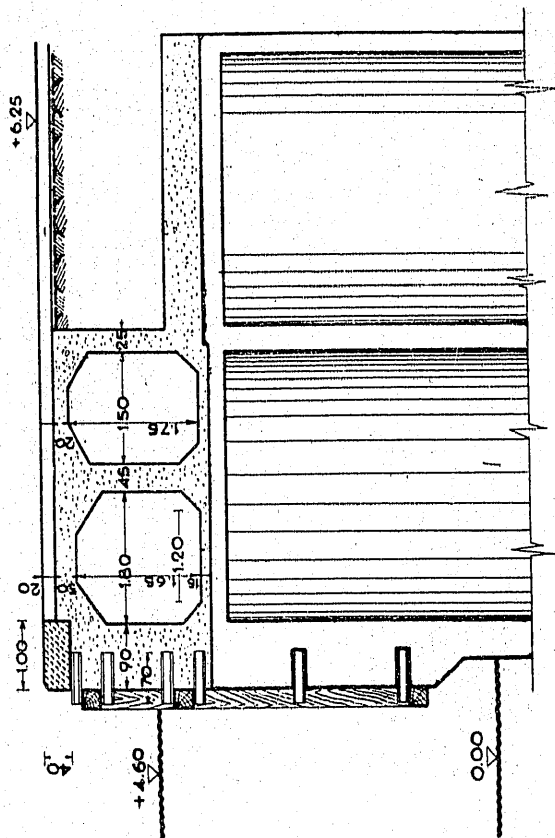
ª — Planta y sección transversal de los bloques y de la superestructura.
